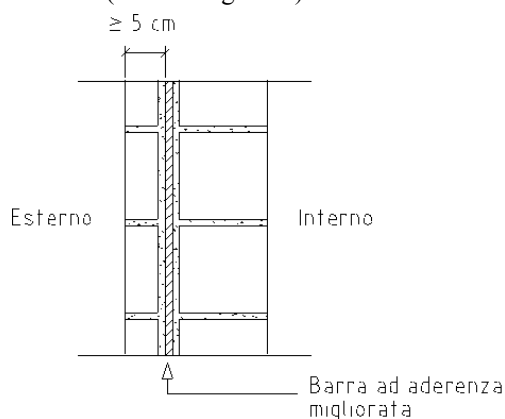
Distanza minima delle barre di armatura dalla superficie
